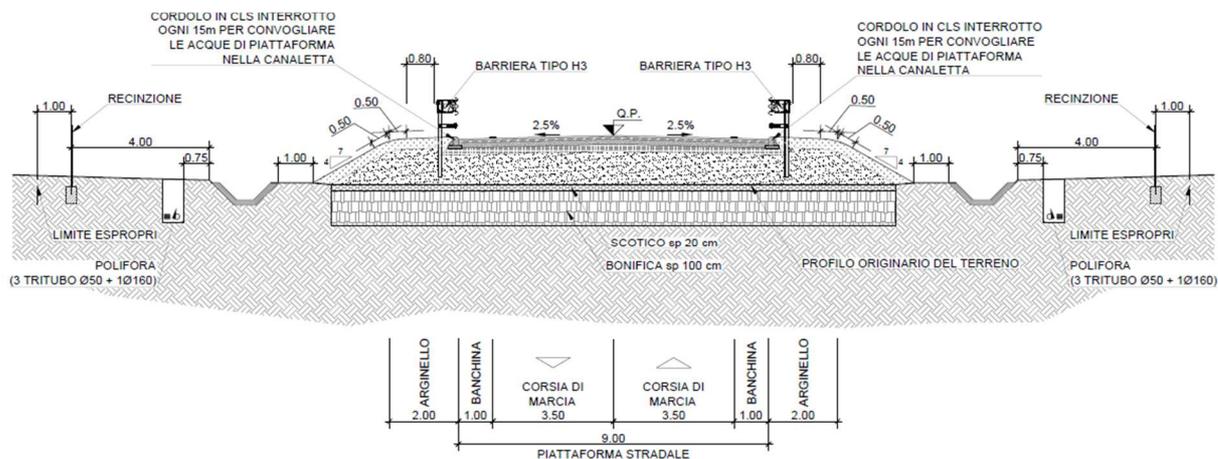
Sezione tipo rami di svincolo in rilevato rampa bidirezionale
